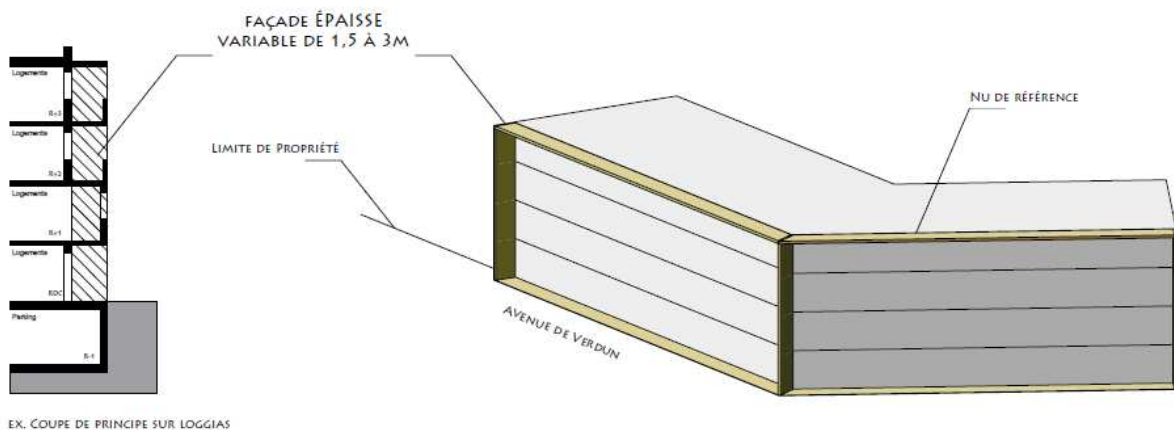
coupe de principe d'une façade épaisse (JAP)
